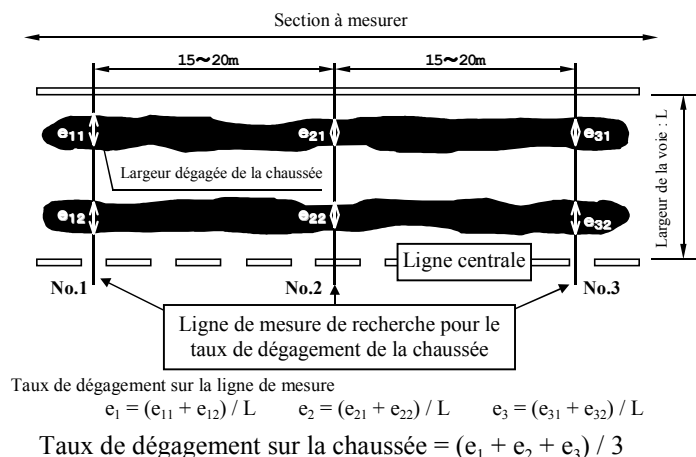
Aperçu de la mesure du taux de dégagement de la chaussée ⁵⁾
